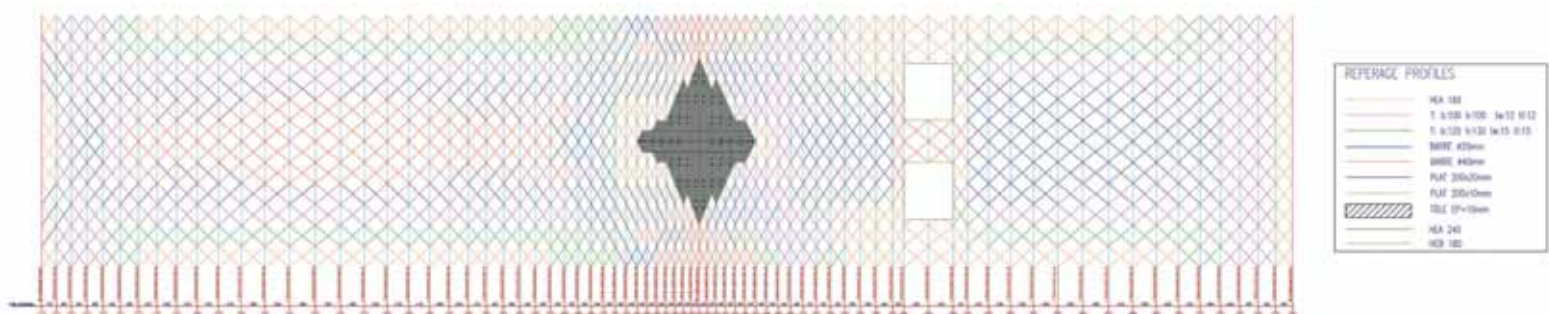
Pianta della struttura del ponte aperta e sviluppata in piano con indicazione dei diversi profili tramite diversi colori. (©HDA)
